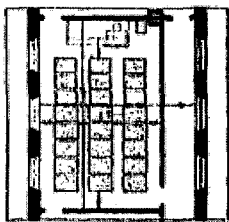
Plan d'une classe à éclairage unilatéral.
